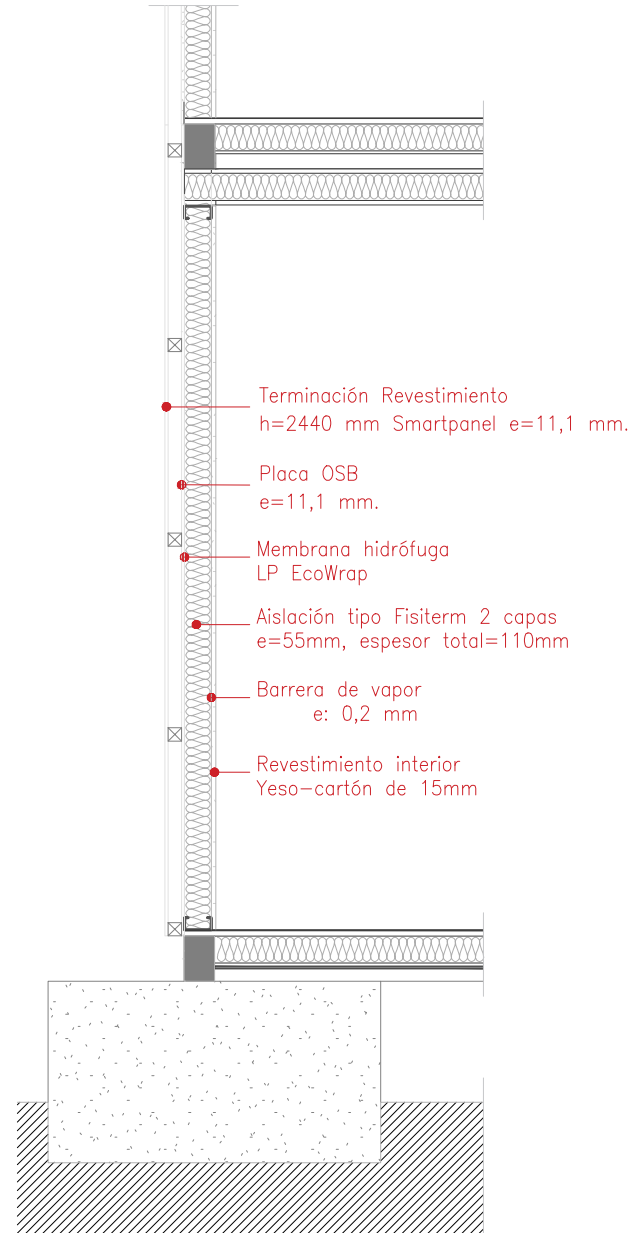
Detalle constructivo del muro del sistema modular ATCO-Sabinco.
